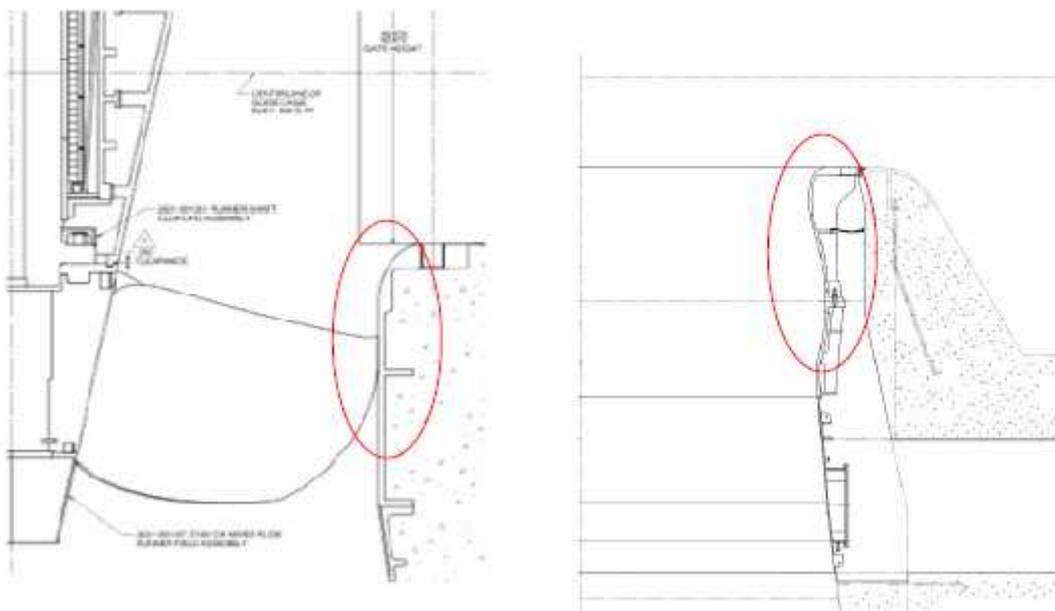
Detalhe da alteração do perfil do aro câmara.
